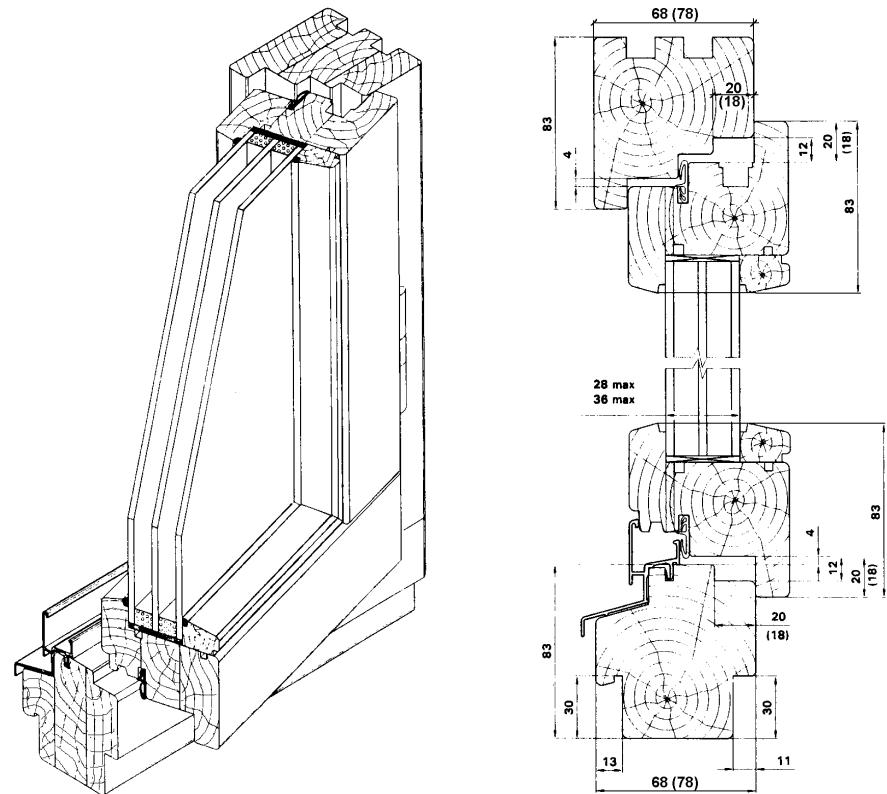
Фрагмент деревянного окна с двойным стеклопакетом
